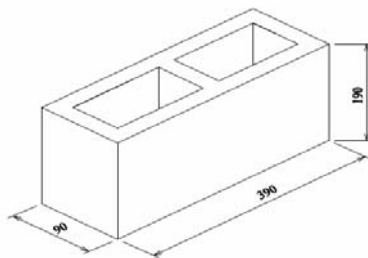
Bloco de concreto de vedação utilizado nos ensaios
